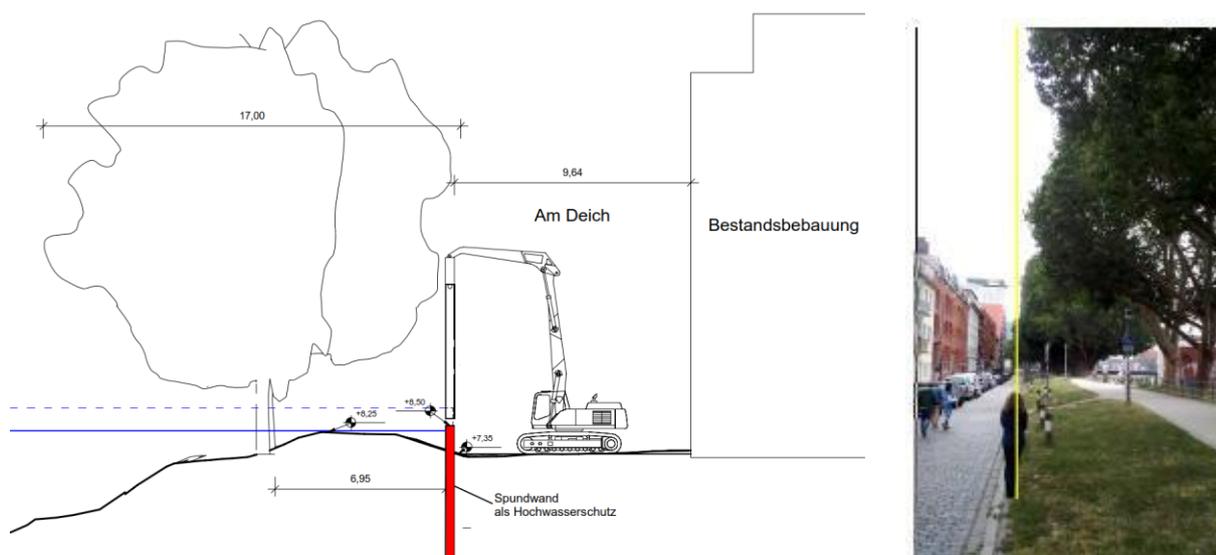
Spundwandeinbringung Bereich „Am Deich“, Querschnitt und Foto
